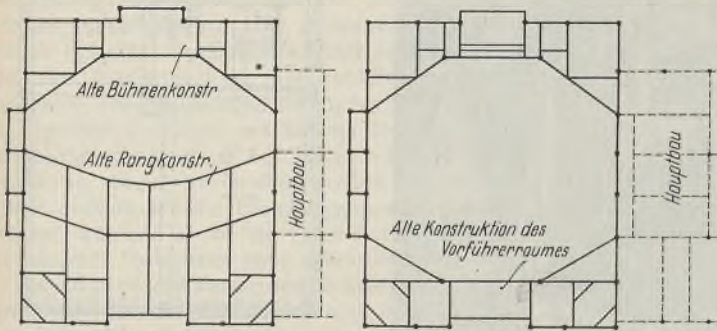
Abb. 3 u. 3a. Grundrisse des Theaterraumes vor dem Umbau.
